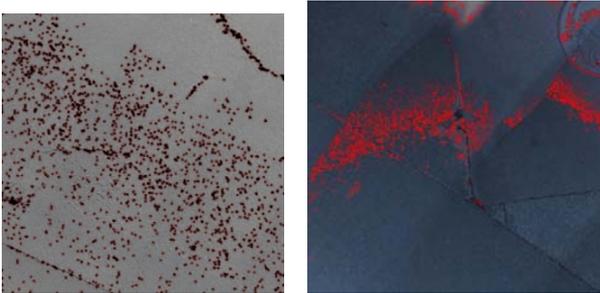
田中²⁾の手法によるひび割れ抽出.
